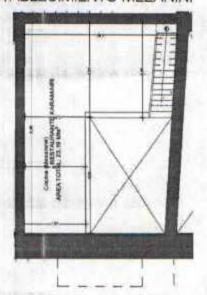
Plano RESTAURANTE KARAMAIRI - Area privada
